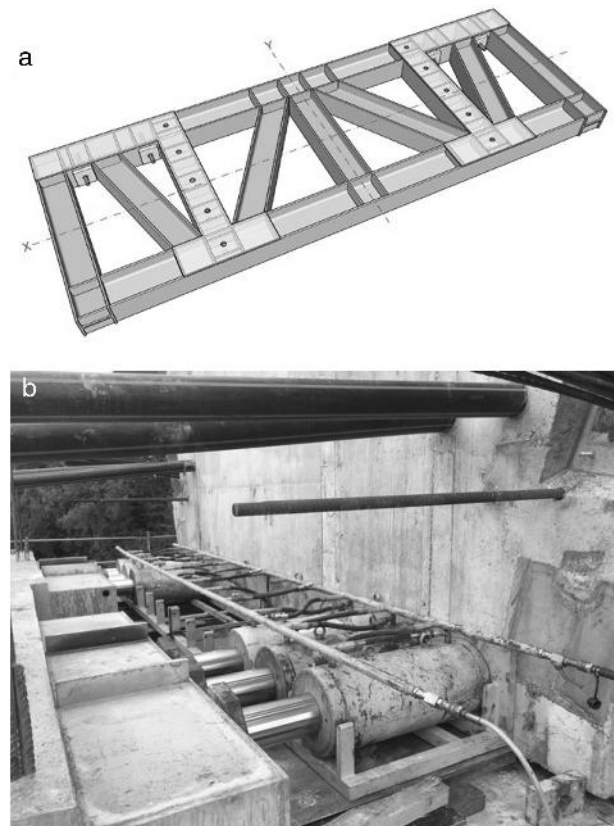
Viga de arrastre (arriba) y gatos de apoyo auxiliar sobre espaldón de estribo (abajo).
